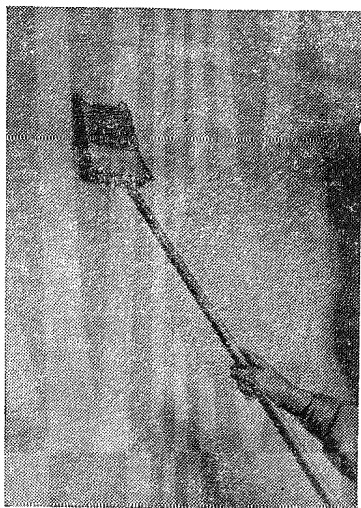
Приспособление для очистки поверхностей на длинной ручке
